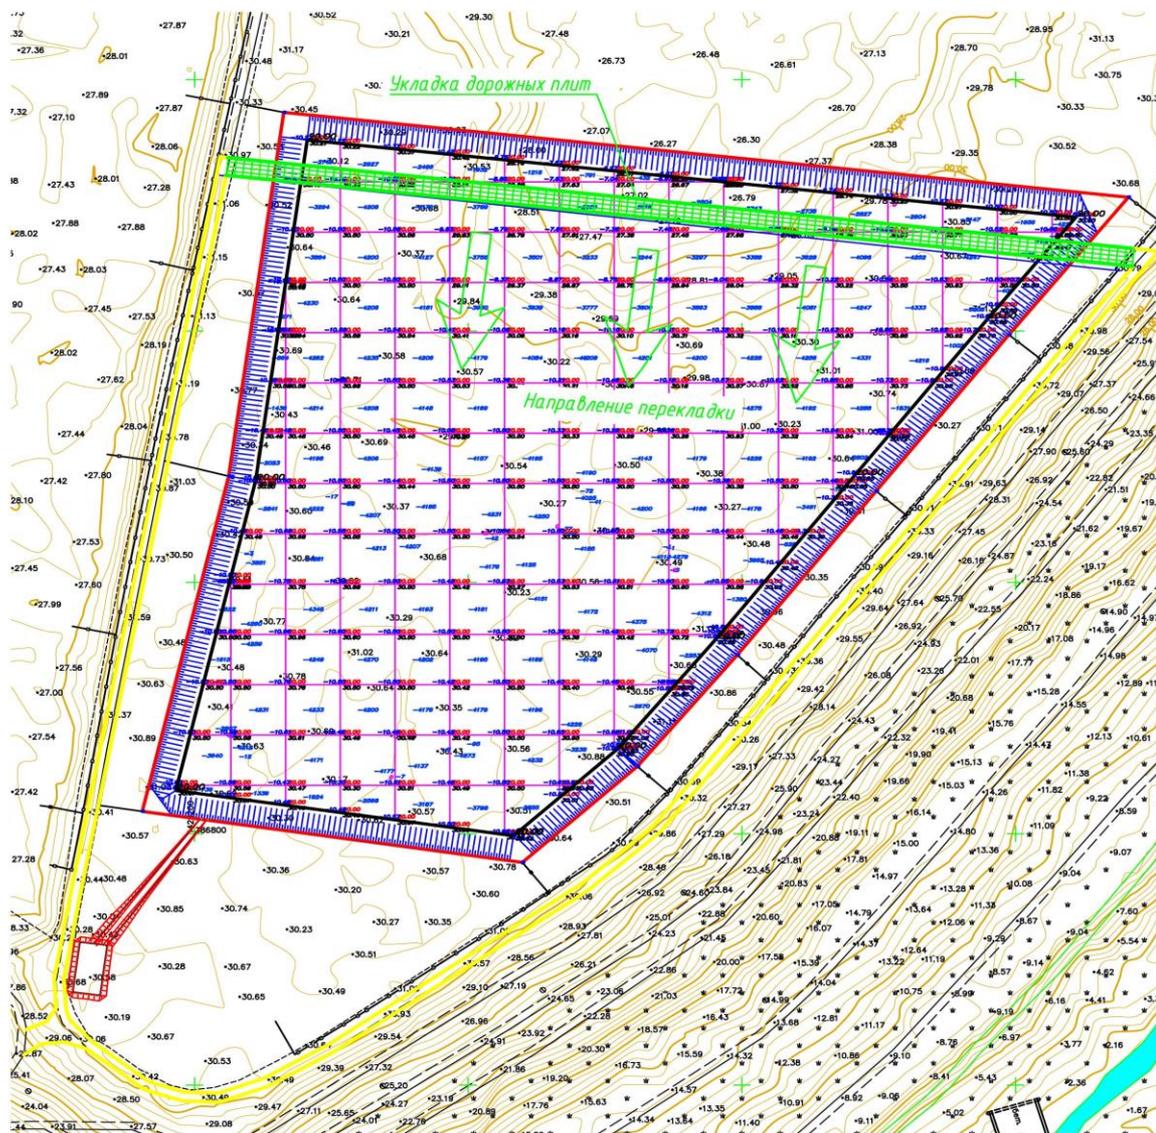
Схема проезда и укладки железобетонных плит и направление работ
